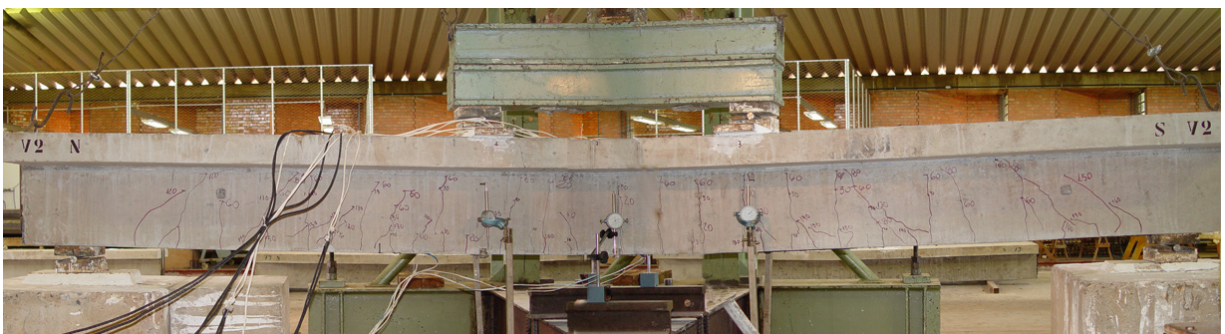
Fissuração na viga VA – RBC, após o ensaio
